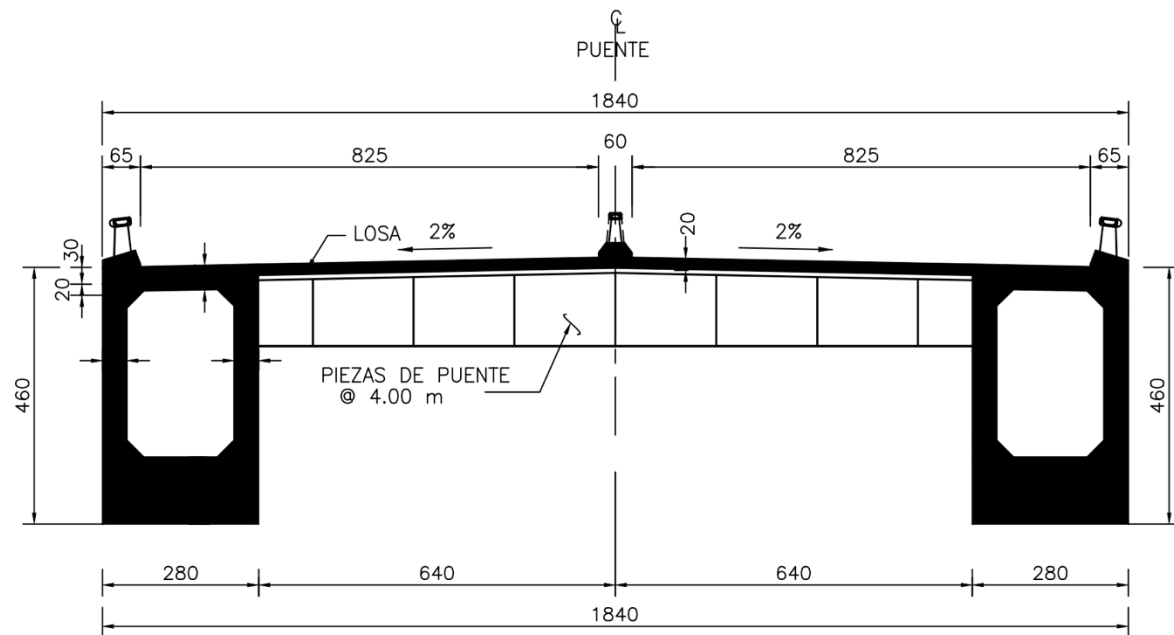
Sección transversal máxima Pila No.3. [cm]
